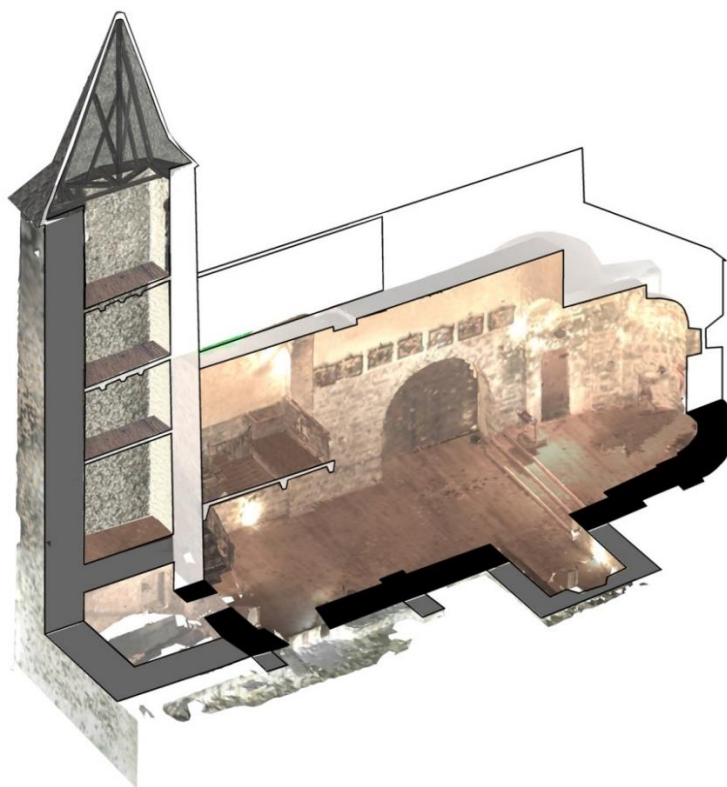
Planimetría de la Iglesia de Sant Pèir de Betlan. e.:1/200.
